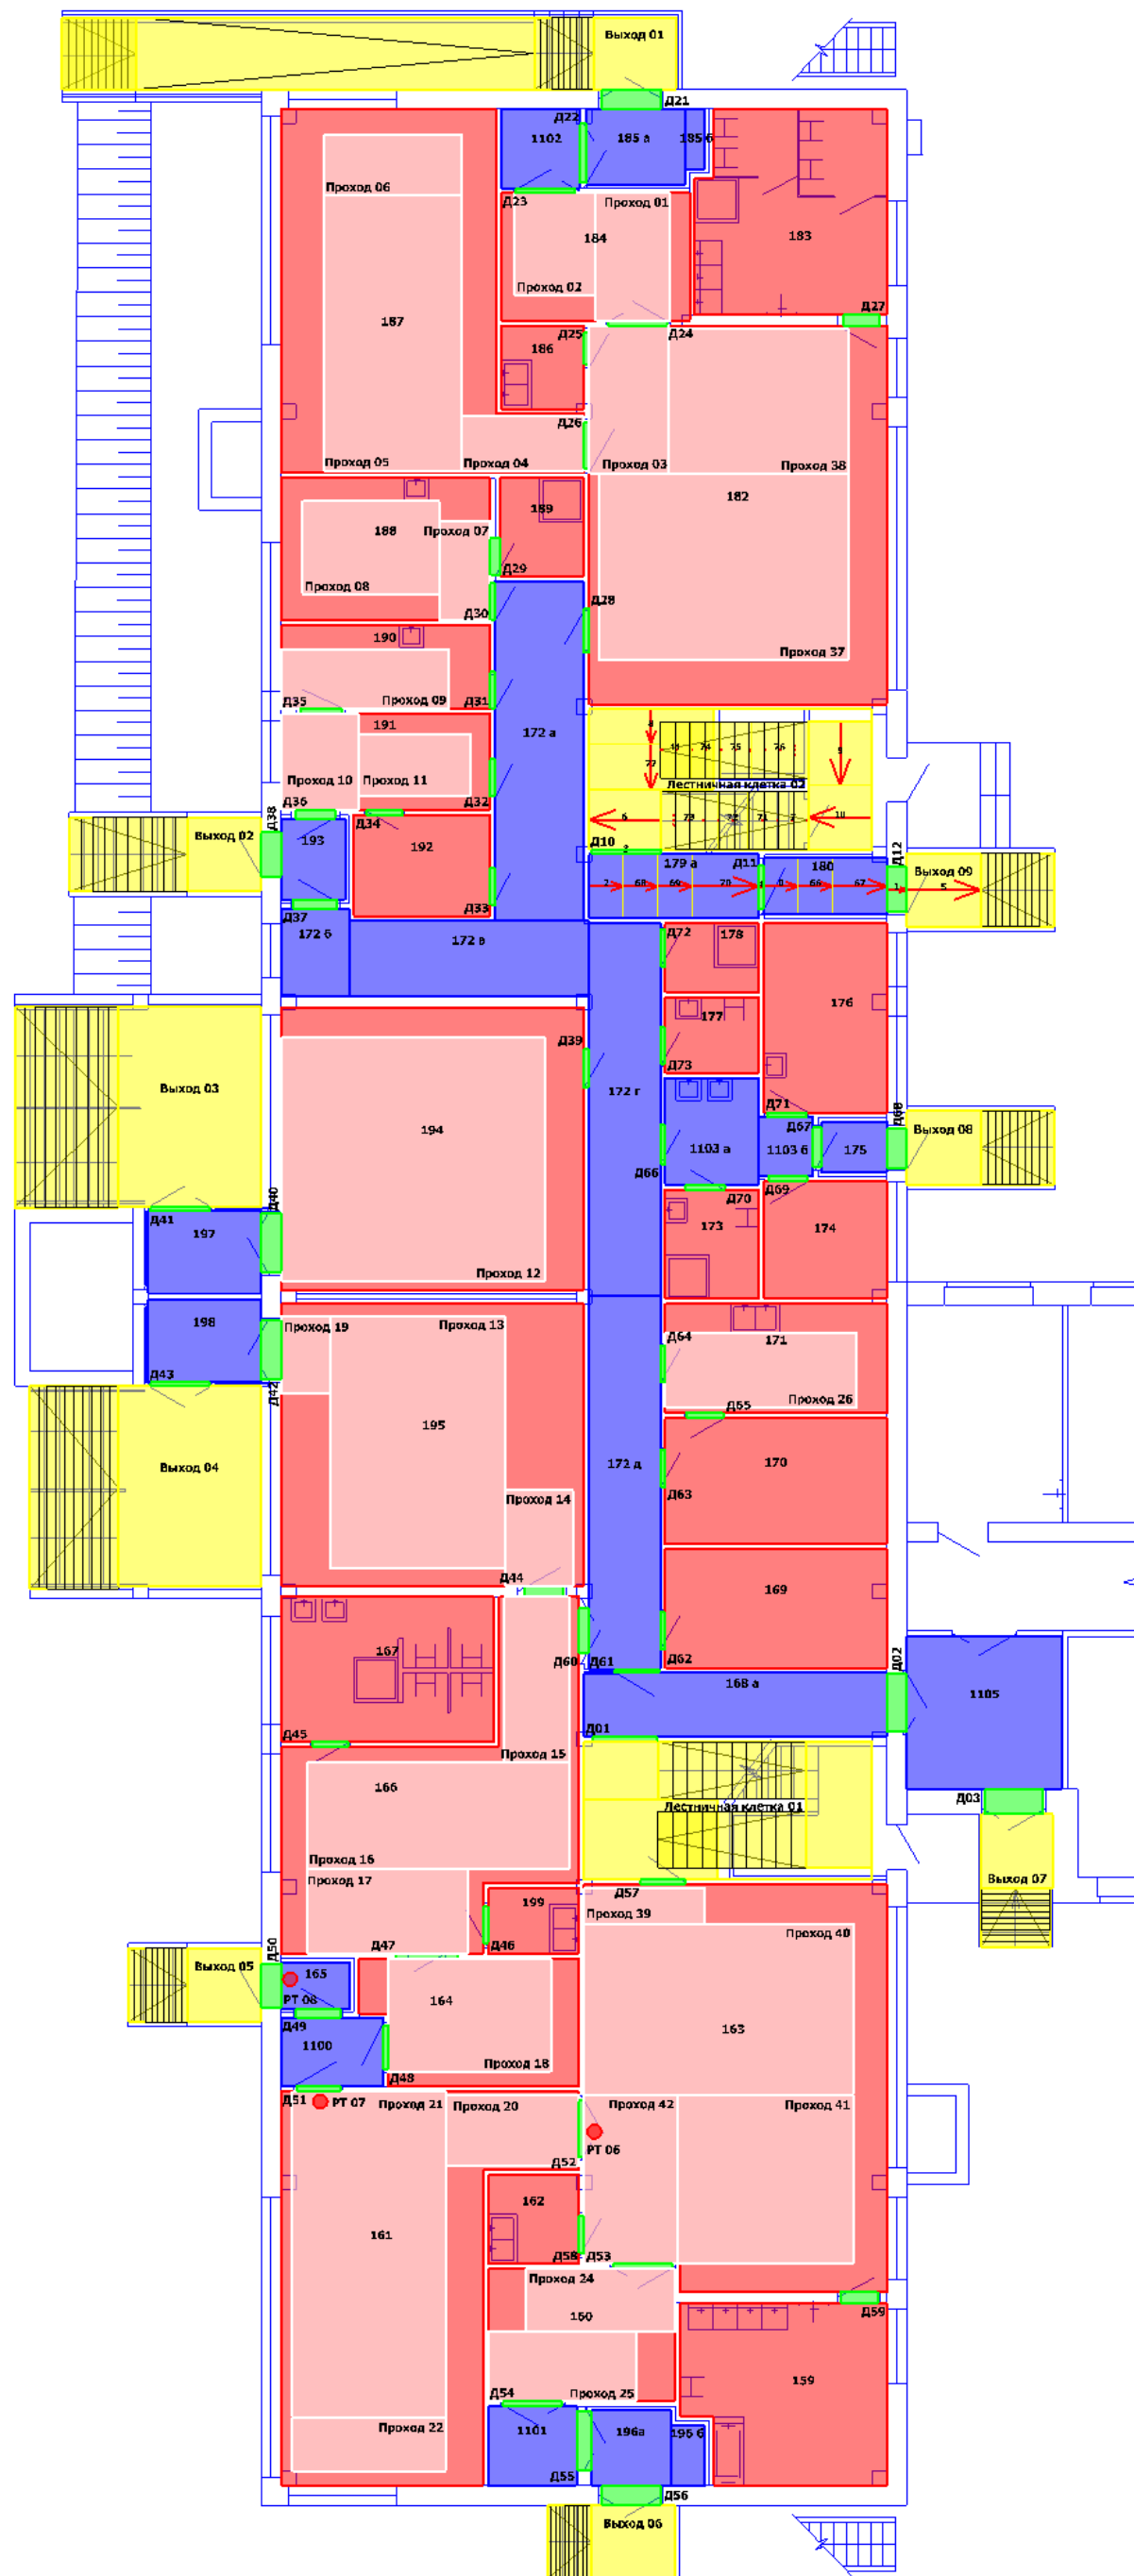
Схема разбиения на участки маршрутов эвакуации из помещений 1-го этажа здания Детского сада на 60 мест с начальной школой на 100 учащихся (Сценарий 02)
